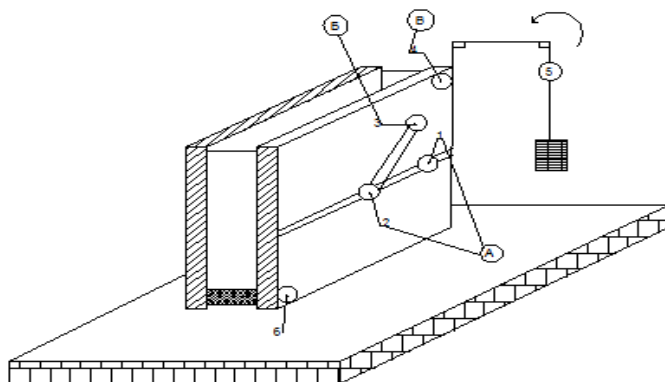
Экспериментальная установка для замера отрывного усилия опалубки
